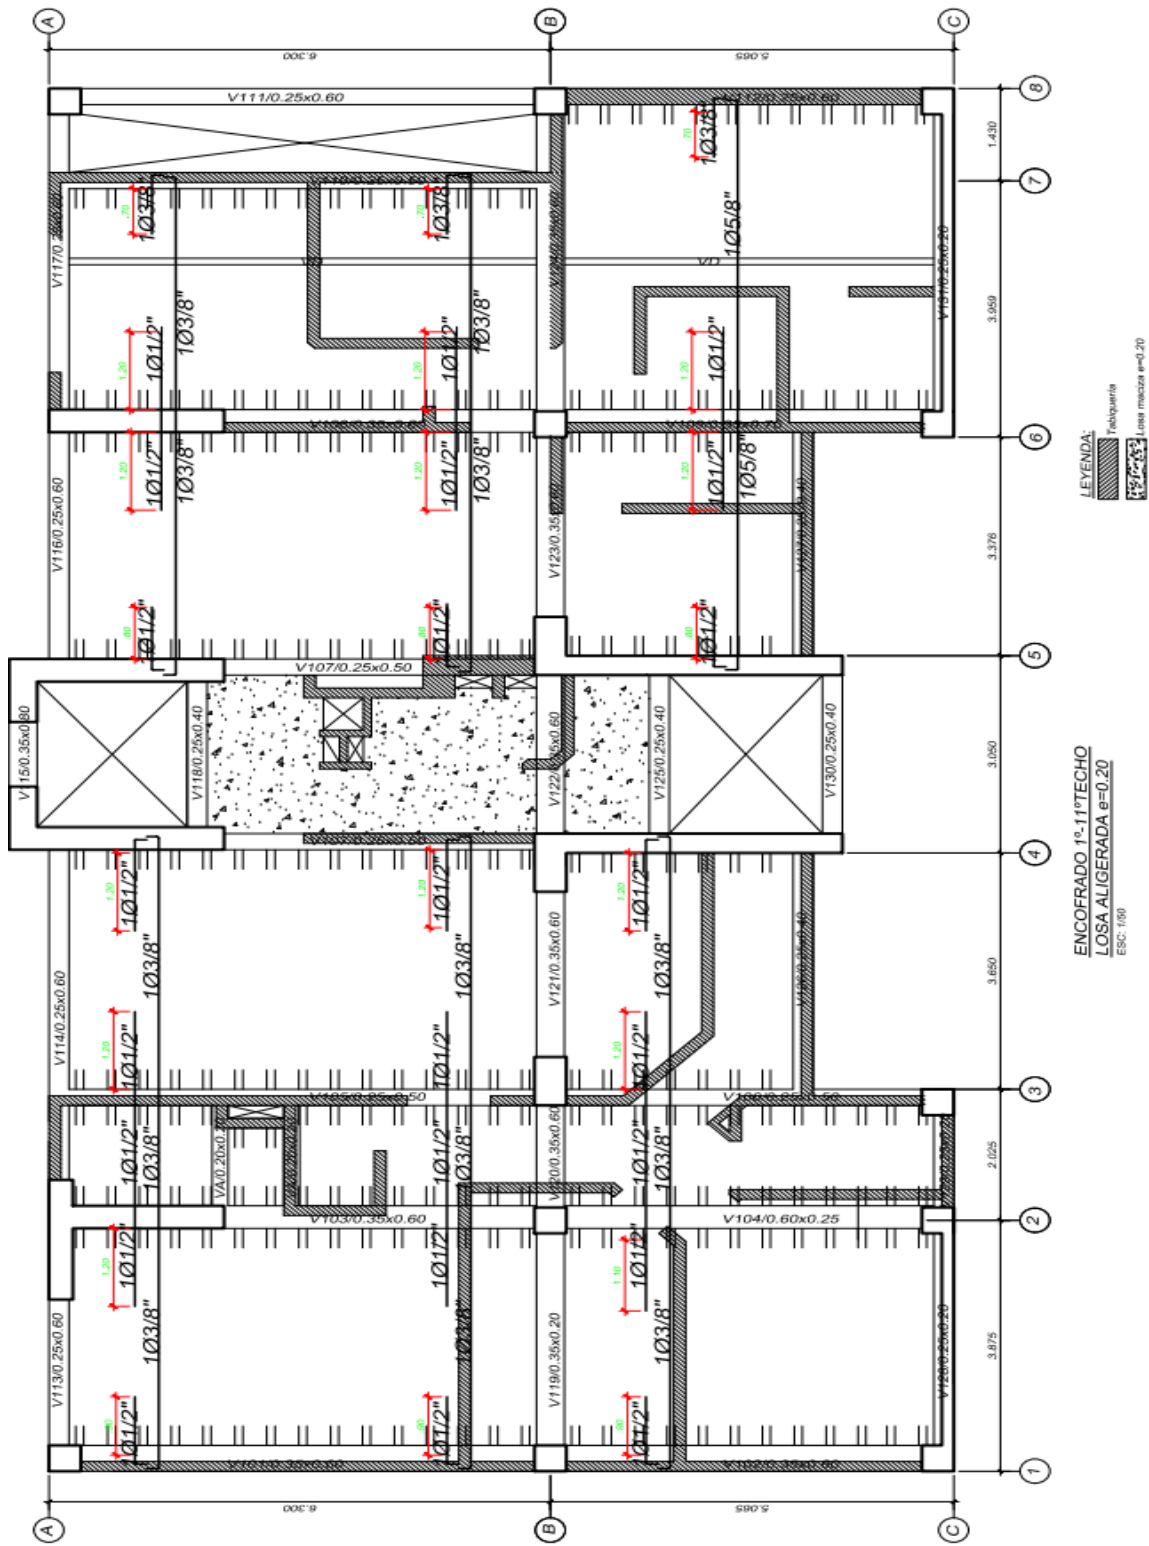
Detallado del refuerzo dispuesto en la losa aligerada Ig
